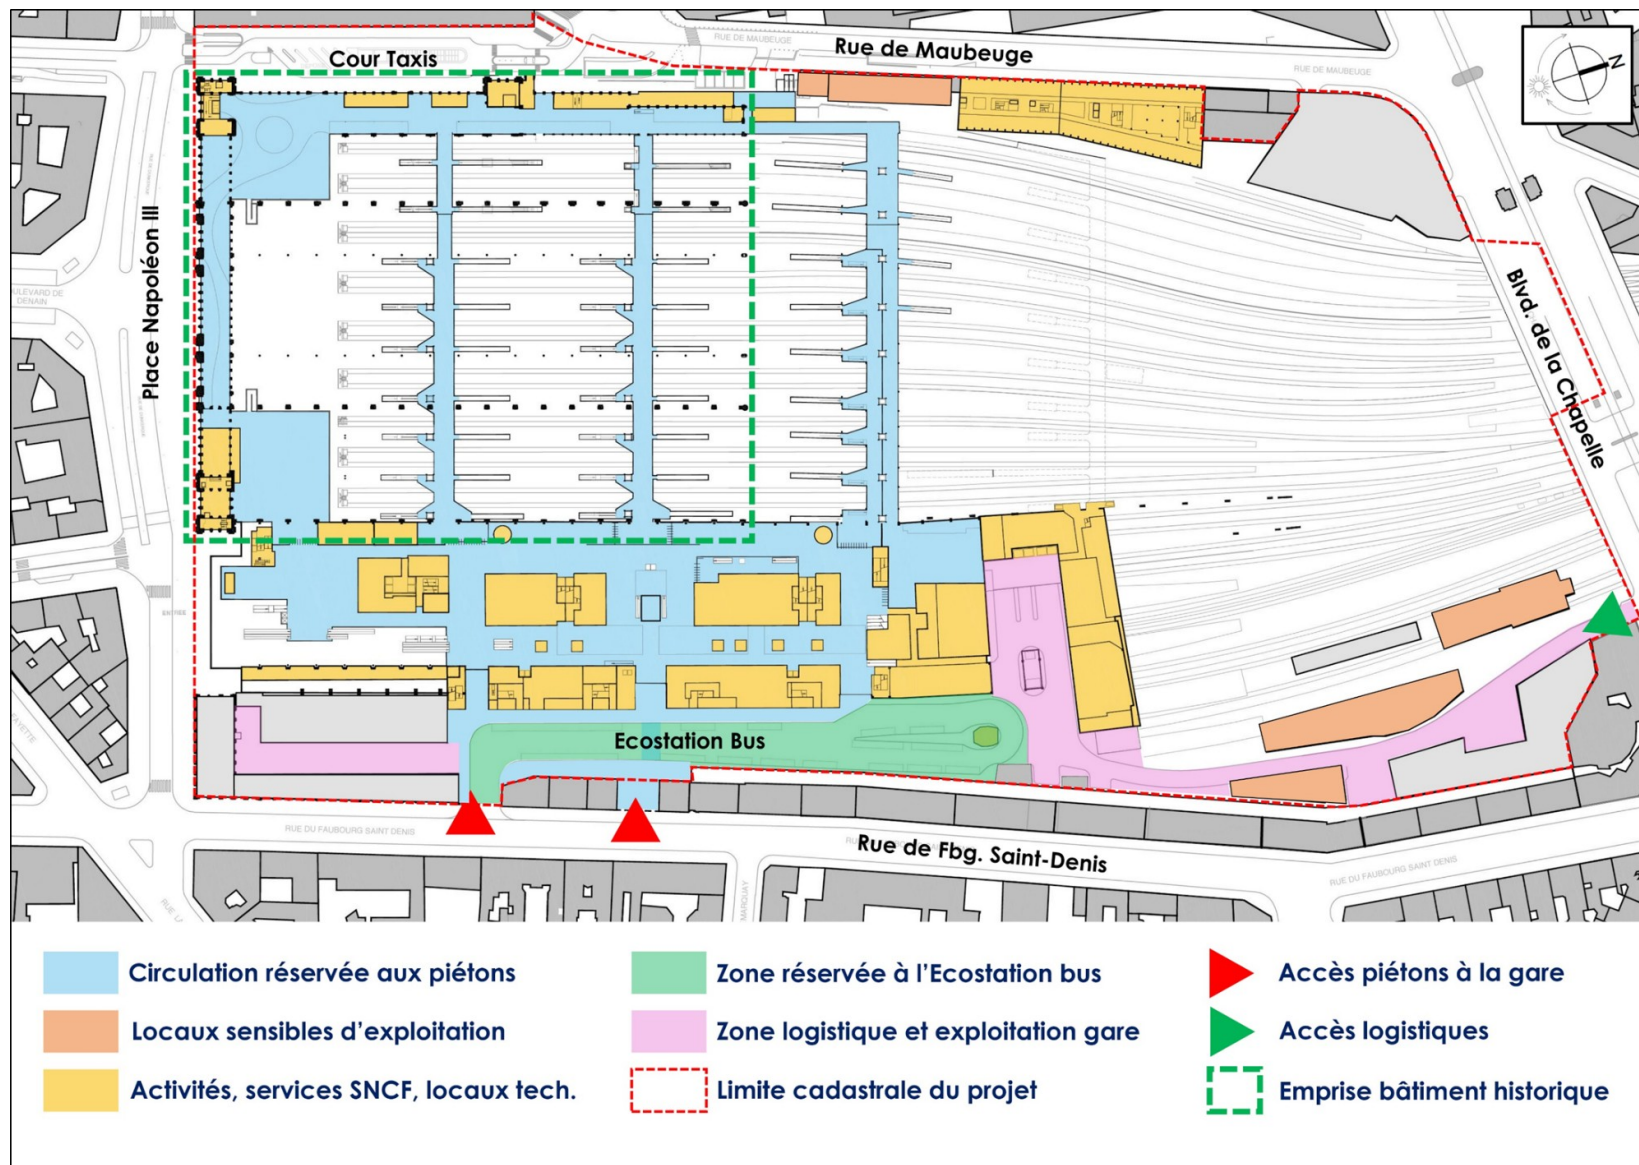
Plan du niveau N01 montrant l'occupation du site
